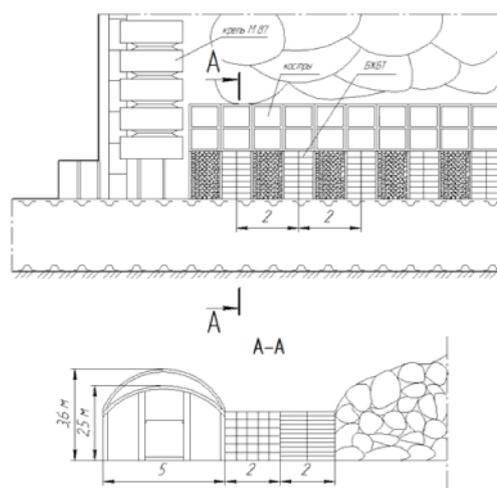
Схема охраны подготовительной выработки разреженными стенками из БЖБТ.
